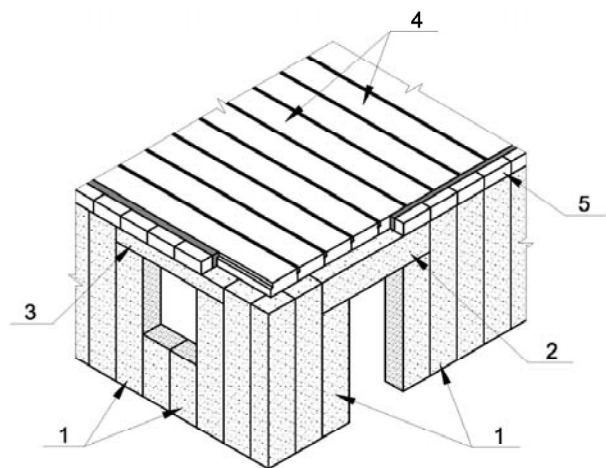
Пример наружных стен из панелей вертикальной разрезки: 1 – вертикальные стеновые панели; 2 – несущая перемычка над дверным проемом; 3 – несущая перемычка над оконным проемом; 4 – сборно-монокричное перекрытие; 5 – кладка из ячеистобетонных блоков в уровне перекрытия
